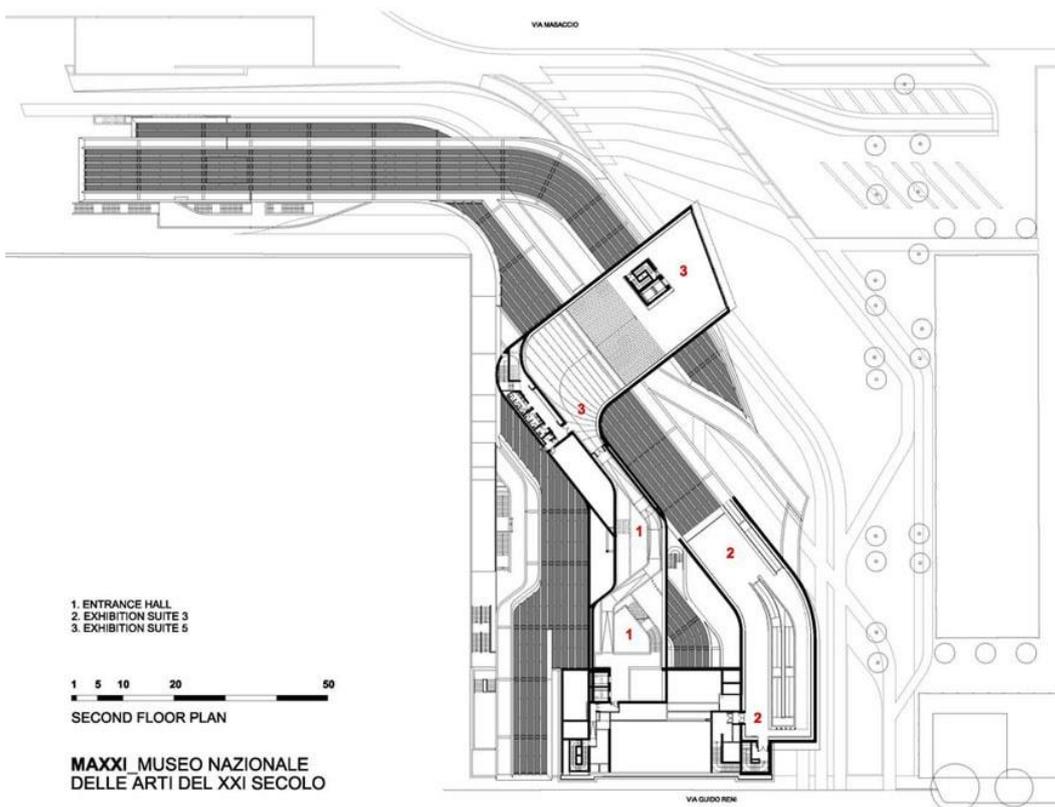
Pianta secondo piano (<https://www.zaha-hadid.com/>)
